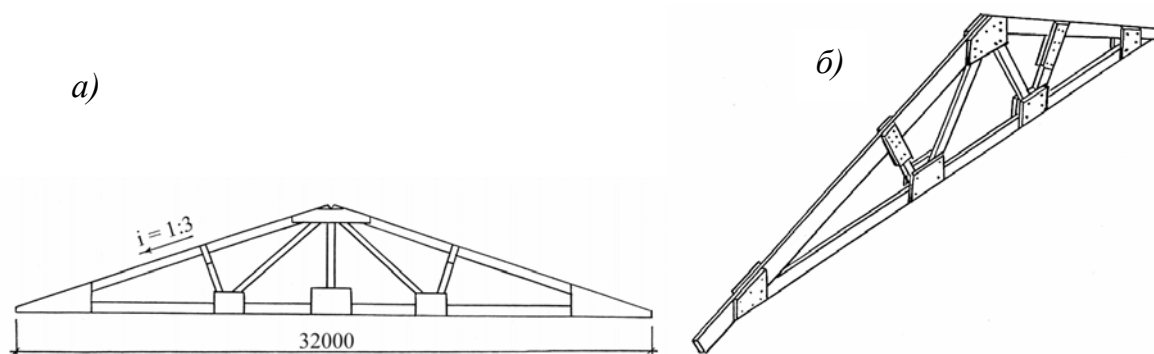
Фермы с узлами на фанерных накладках: а – конструкции США; б – конструкции ФРГ
